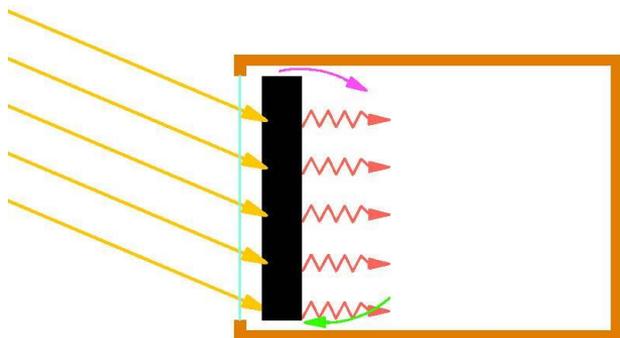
Схема пассивного использования энергии солнца (конструкции Тромба-Мишеля): 1 — солнечная радиация; 2 — поток теплого воздуха в жилое помещение; 3 — наружная стена; 4 — жилое помещение; 5 — поток охлажденного воздуха из жилого помещения; 6 — стеклянная панель
